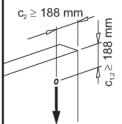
Einbausituation Wandfläche - Querbeanspruchung ohne Betonkantenbruch, ohne Rückhängebewehrung
